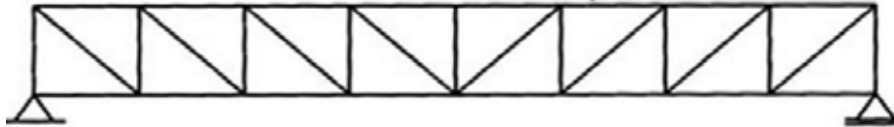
Viga metálica tipo PRATT Fuente: http://www.construmatica.com/construpedia/Viga_Pratt (2016)
